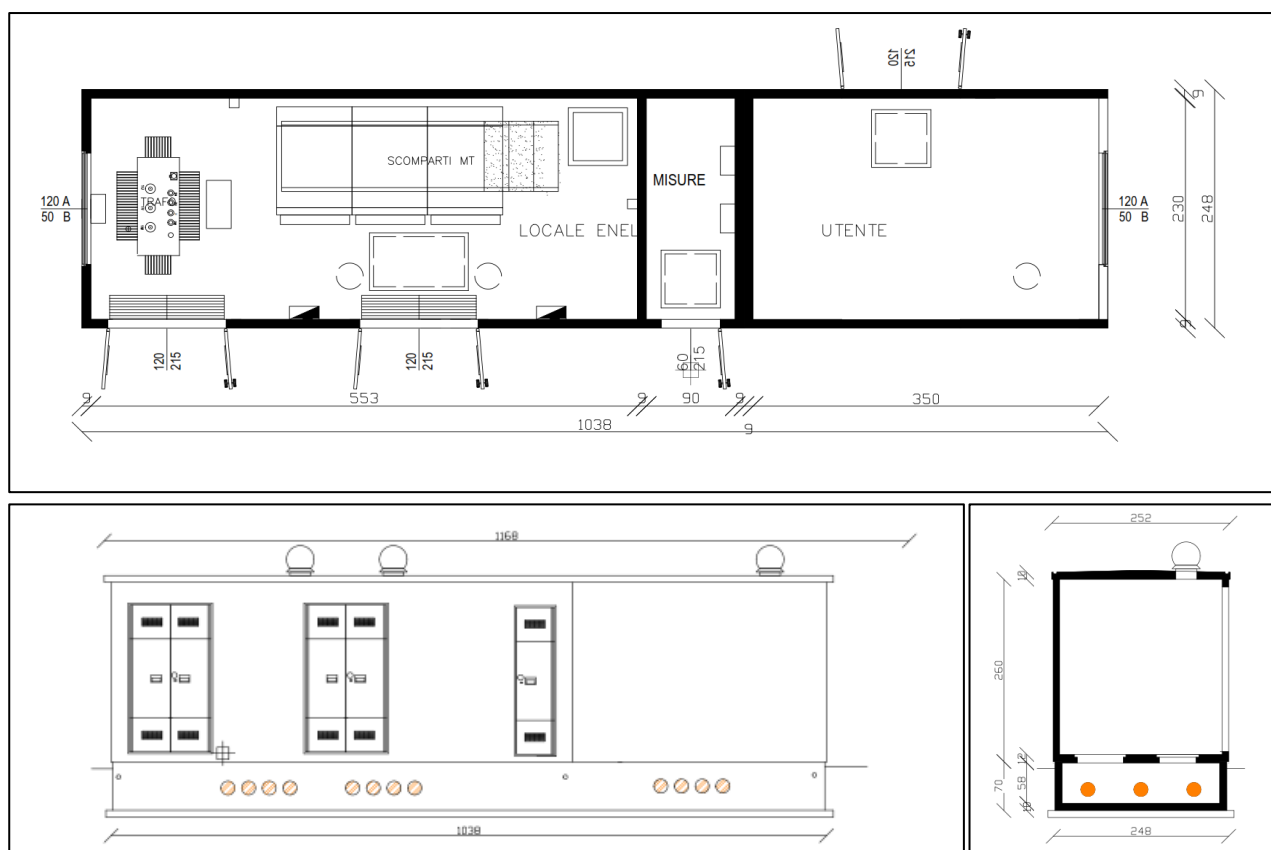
Vista in pianta/prospetto/sezione cabina di consegna.
